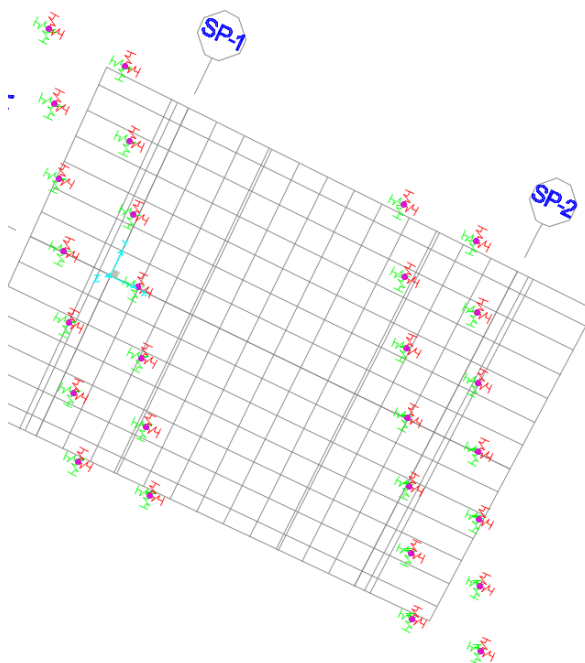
Vista 3D delle spalle (modello di calcolo).
